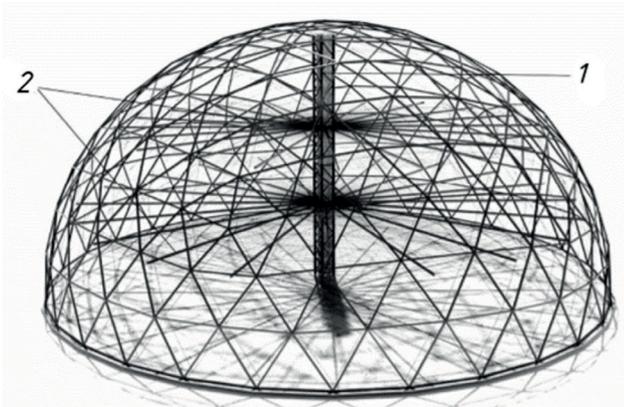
Вид теплицы с центральной опорной колонной и с межуровневыми перекрытиями. 1 – центральная опорная колонна; 2 – межуровневые перекрытия.
